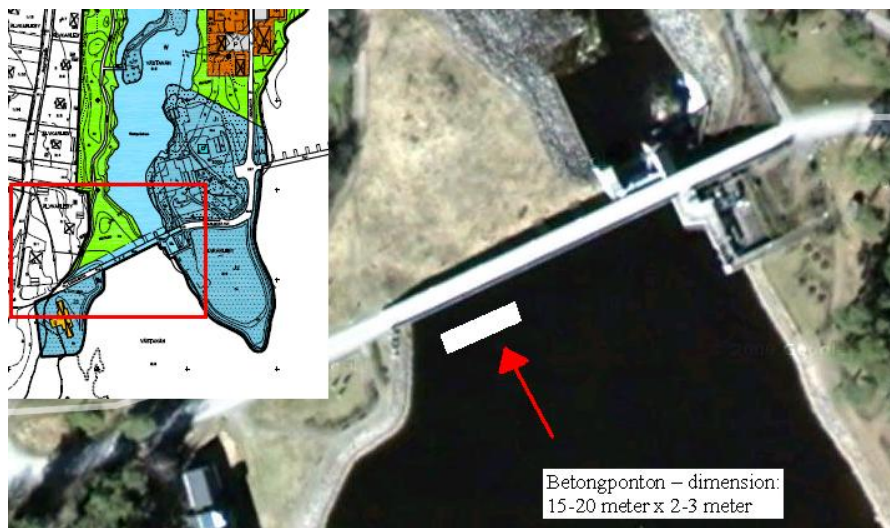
Principiell skiss med placering av betongponton utmed älvkanten.
